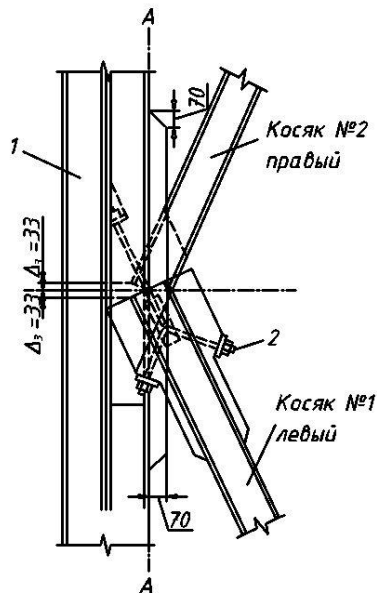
Конструкция фронтового узла. Вид на развернутой поверхности сетки
